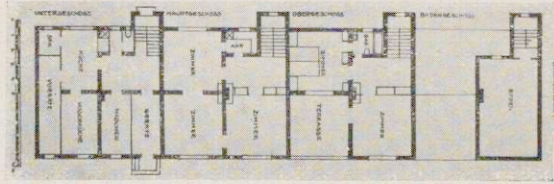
Grundrisse Reihenhäuser I. S. Abb. 10 u. 11
